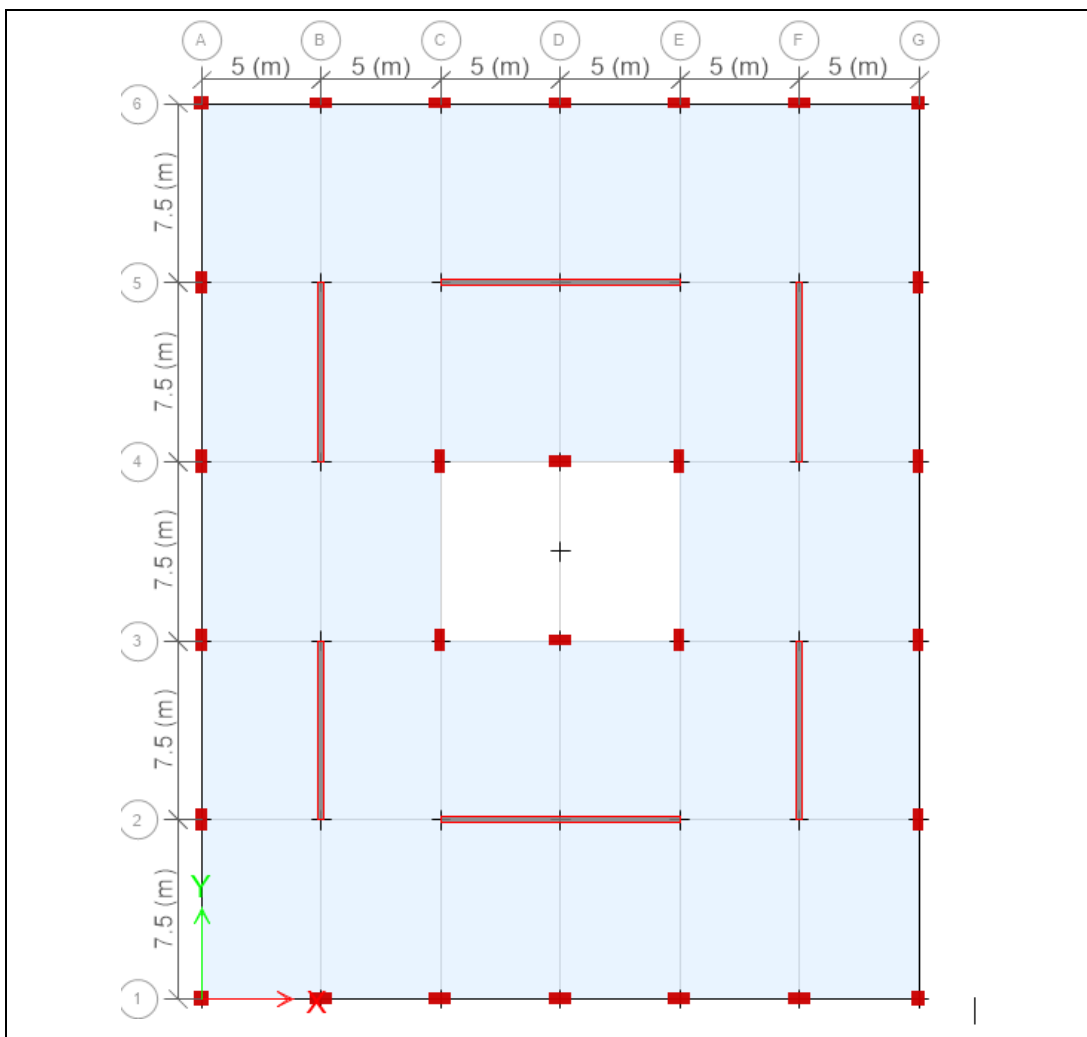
Estructuración de la Planta típica del Sistema convencional; columnas más muros estructurales, Fuente: Propia.
